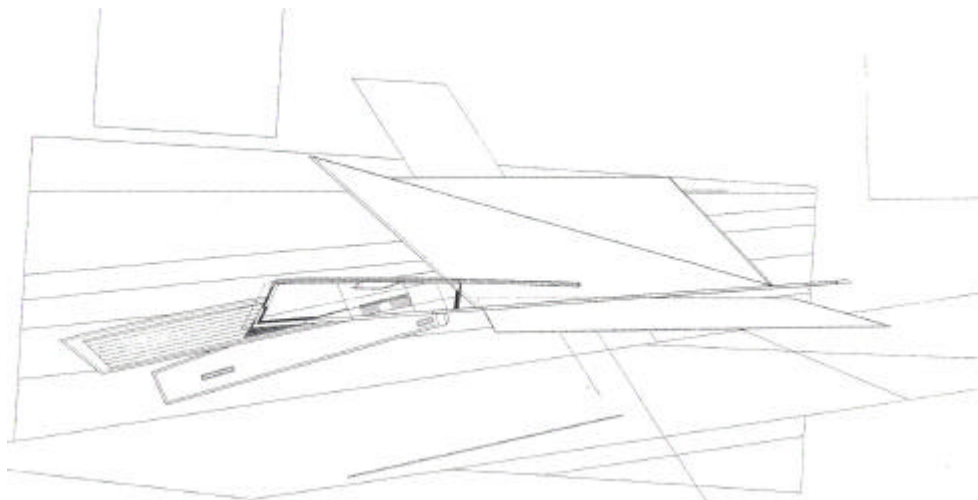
Zaha Hadid, Feuerwache, 1989-1993, Grundriß Obergeschoß
